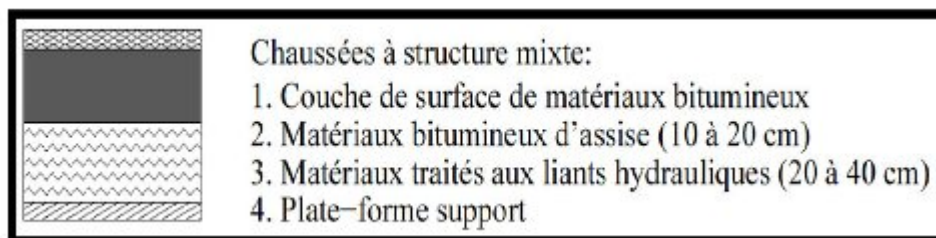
Chaussées à structure mixte (LCPC, 1994).
